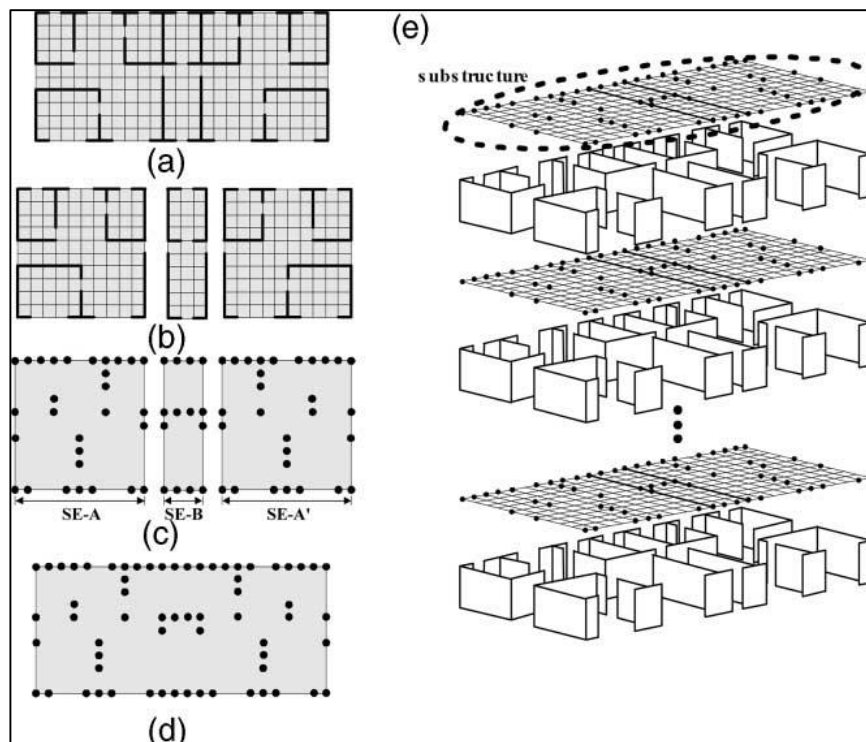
Aplicación de súper elemento y subestructura de losas de piso para el tipo de plano de C. (a) de un plano, (b) División de una losa de piso, (c) Tipos de elementos súper, (d) Subestructura para una losa de piso, losa de piso, (e) El montaje de subestructura.
